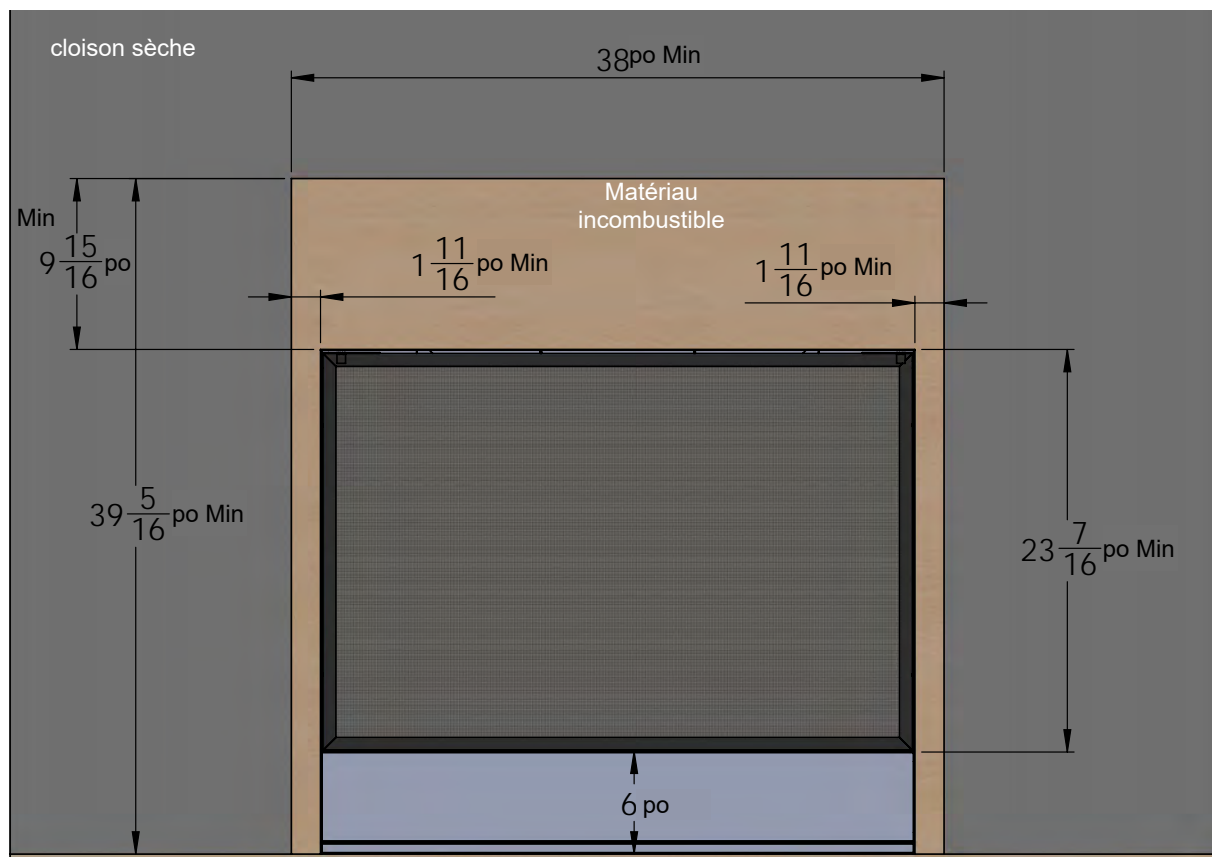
Dimensions des matériaux incombustibles sur la face du foyer
